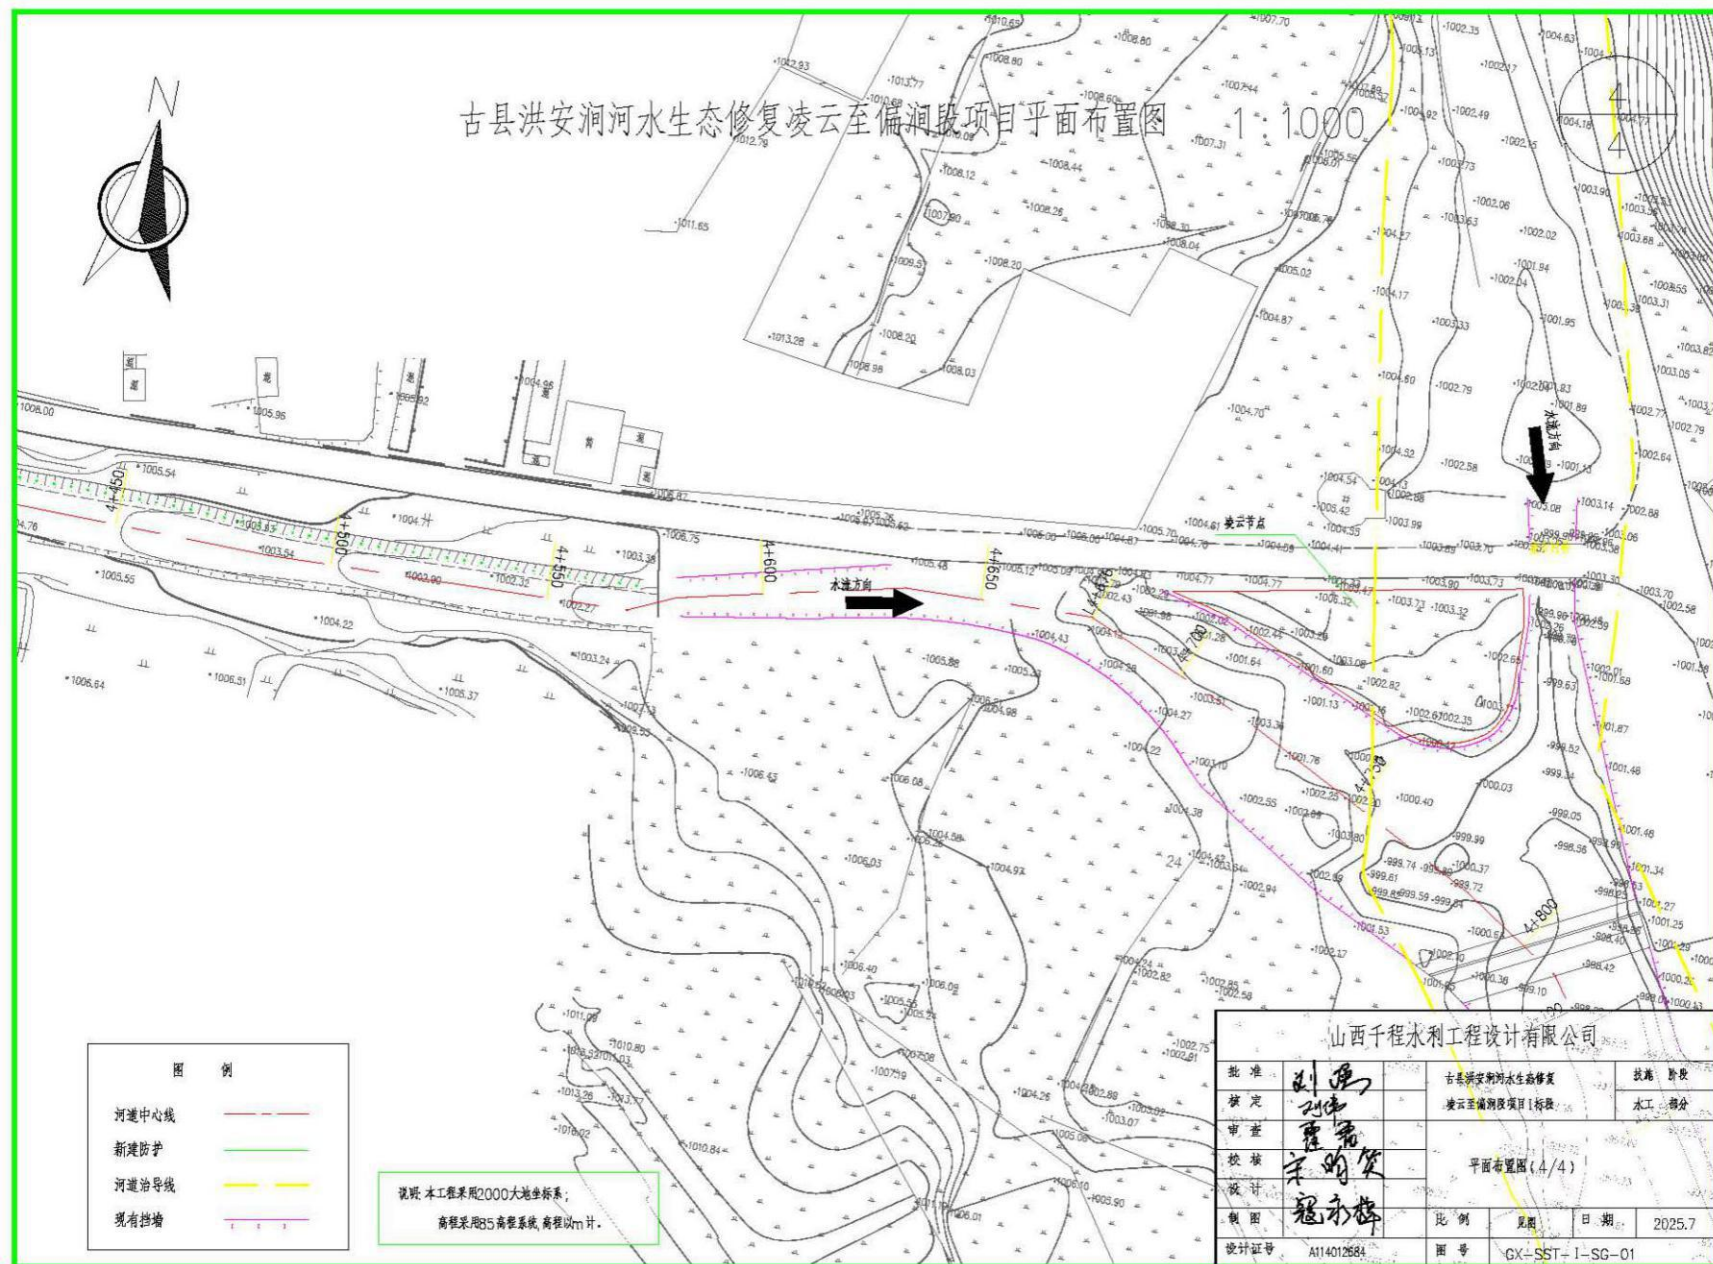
(4) 工程总平面布置图(桩号4+400-4+750)
